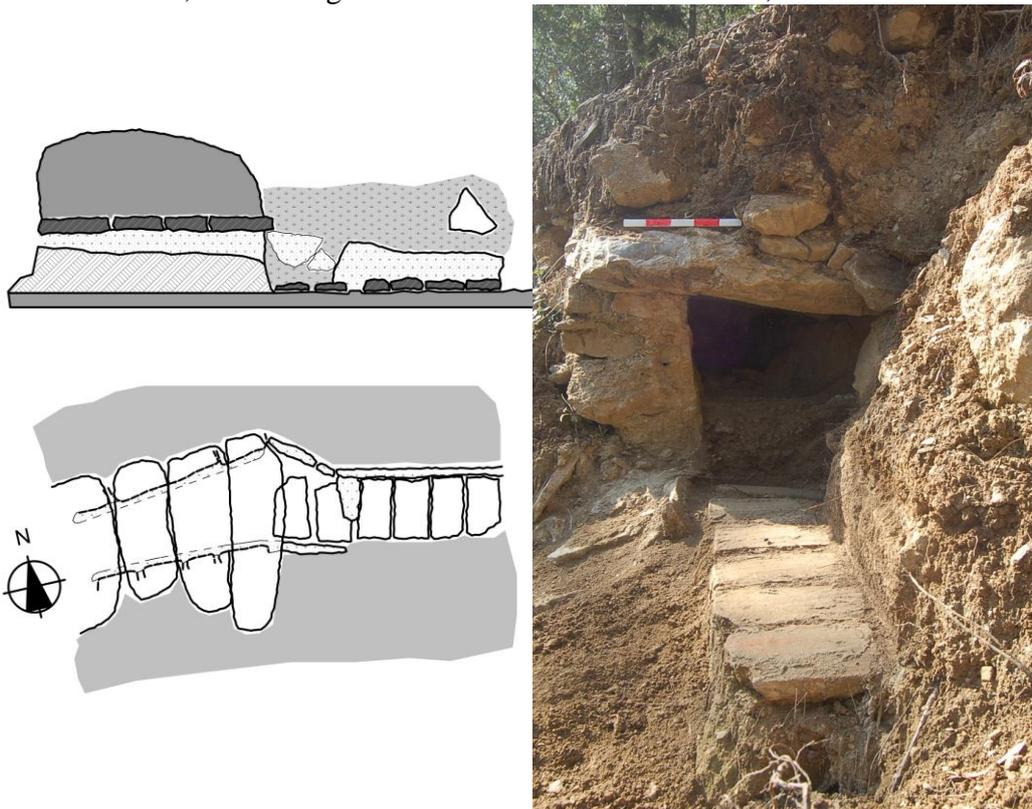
Plan et coupe et photo du *specus* de l'aqueduc de Gouraya qui collecte la source près de la maison Bara
